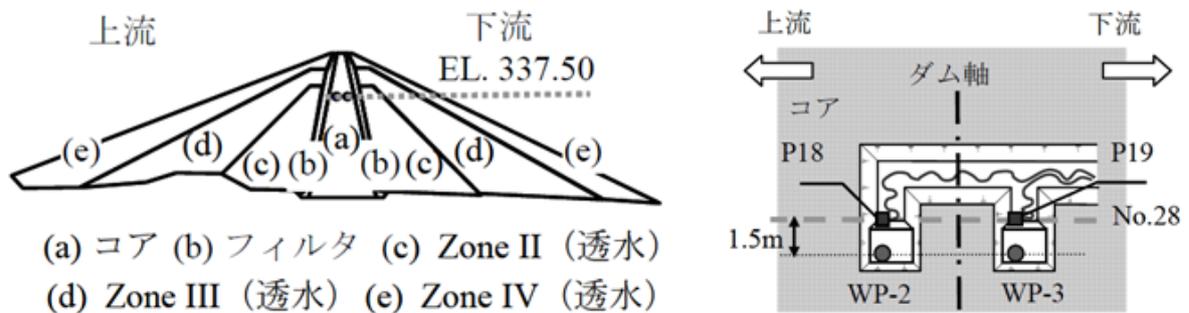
地中無線のダムへの適用事例（左：ダム概観、右：設置平面図）[35]
